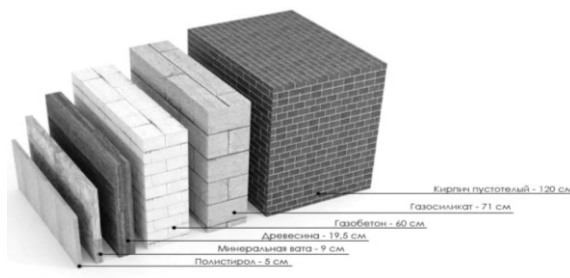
Толщины стен из разных строительных материалов при равной теплоизоляции
